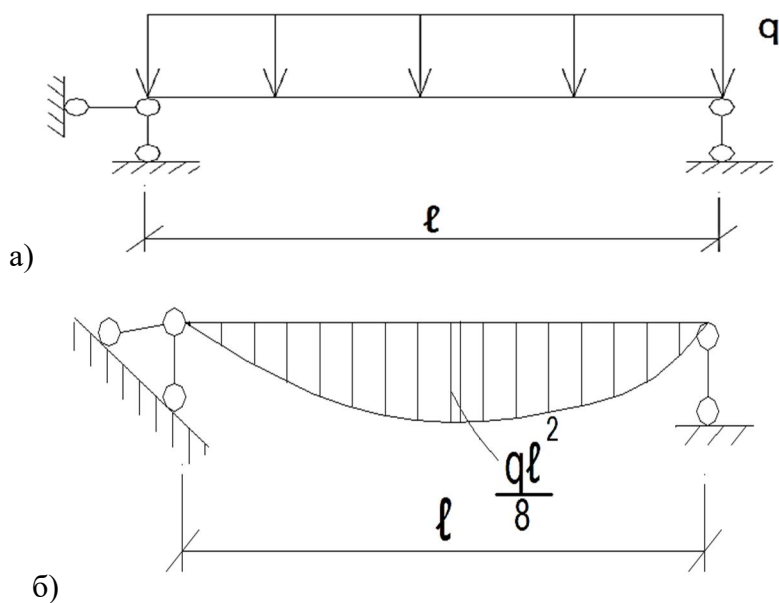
Балочная плита перекрытия: а) расчетная схема балочной плиты; б) эпюра изгибающих моментов
